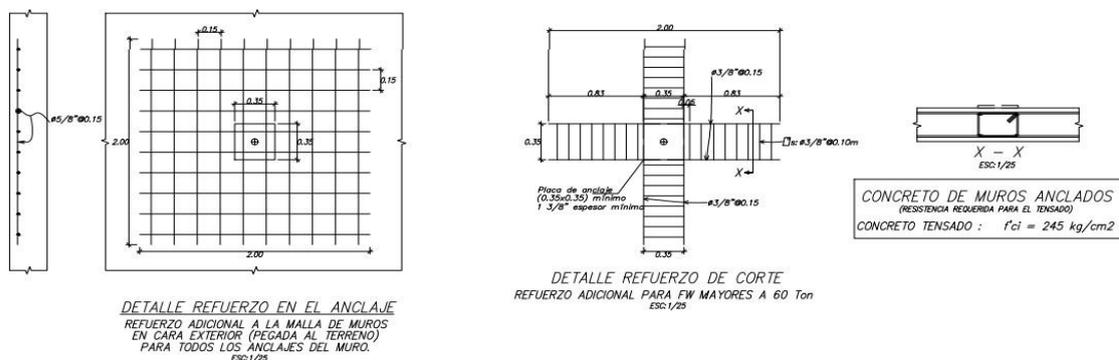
Detalle de refuerzo en cruz adicional para anclajes que superen las 70 tn
